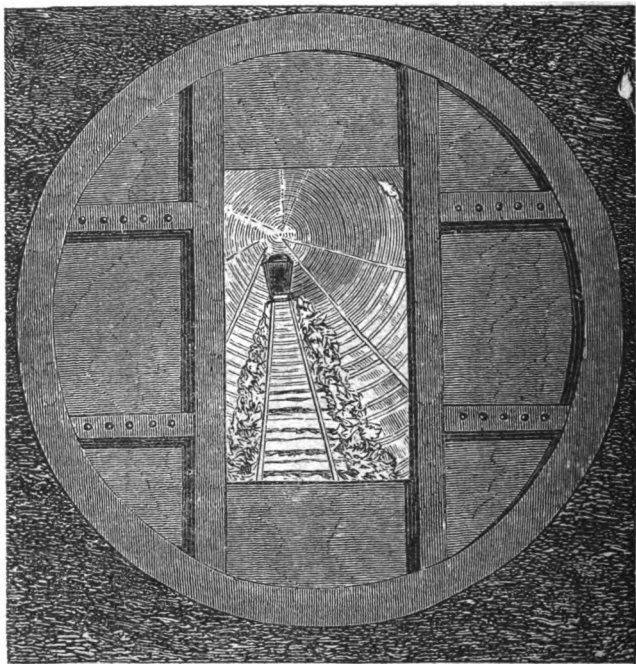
Nuovo tunnel sotto il Tamigi a Londra.
